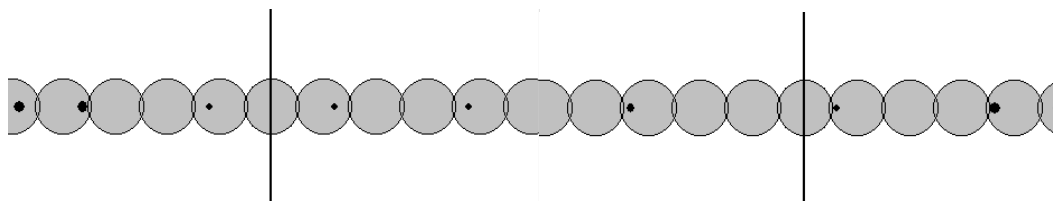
Sección transversal muro pisos 2 al 6 modelo UCSD_1_T1
